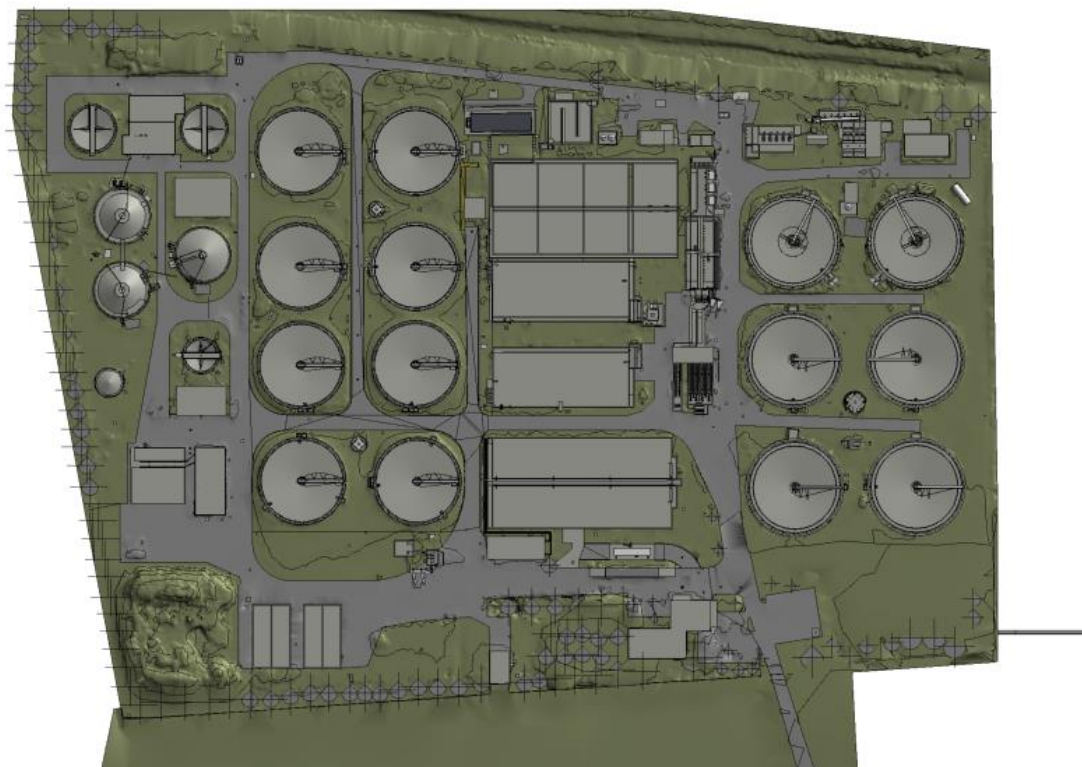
Layout stato di fatto impianto di depurazione di Ravenna
